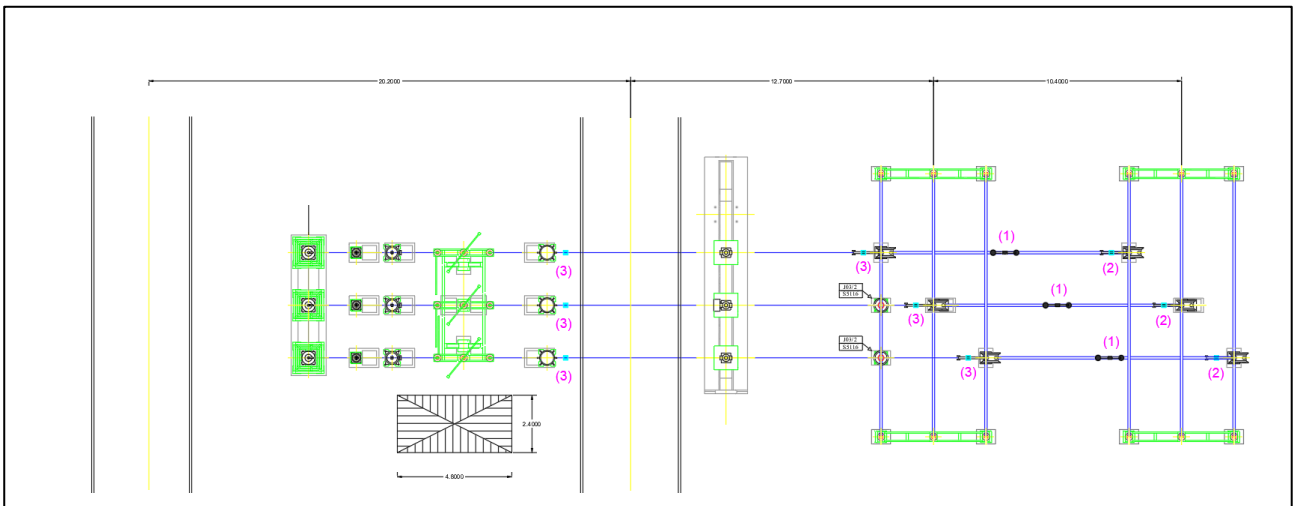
Planimetria elettromeccanica Stallo Arrivo Produttore 132 kV
